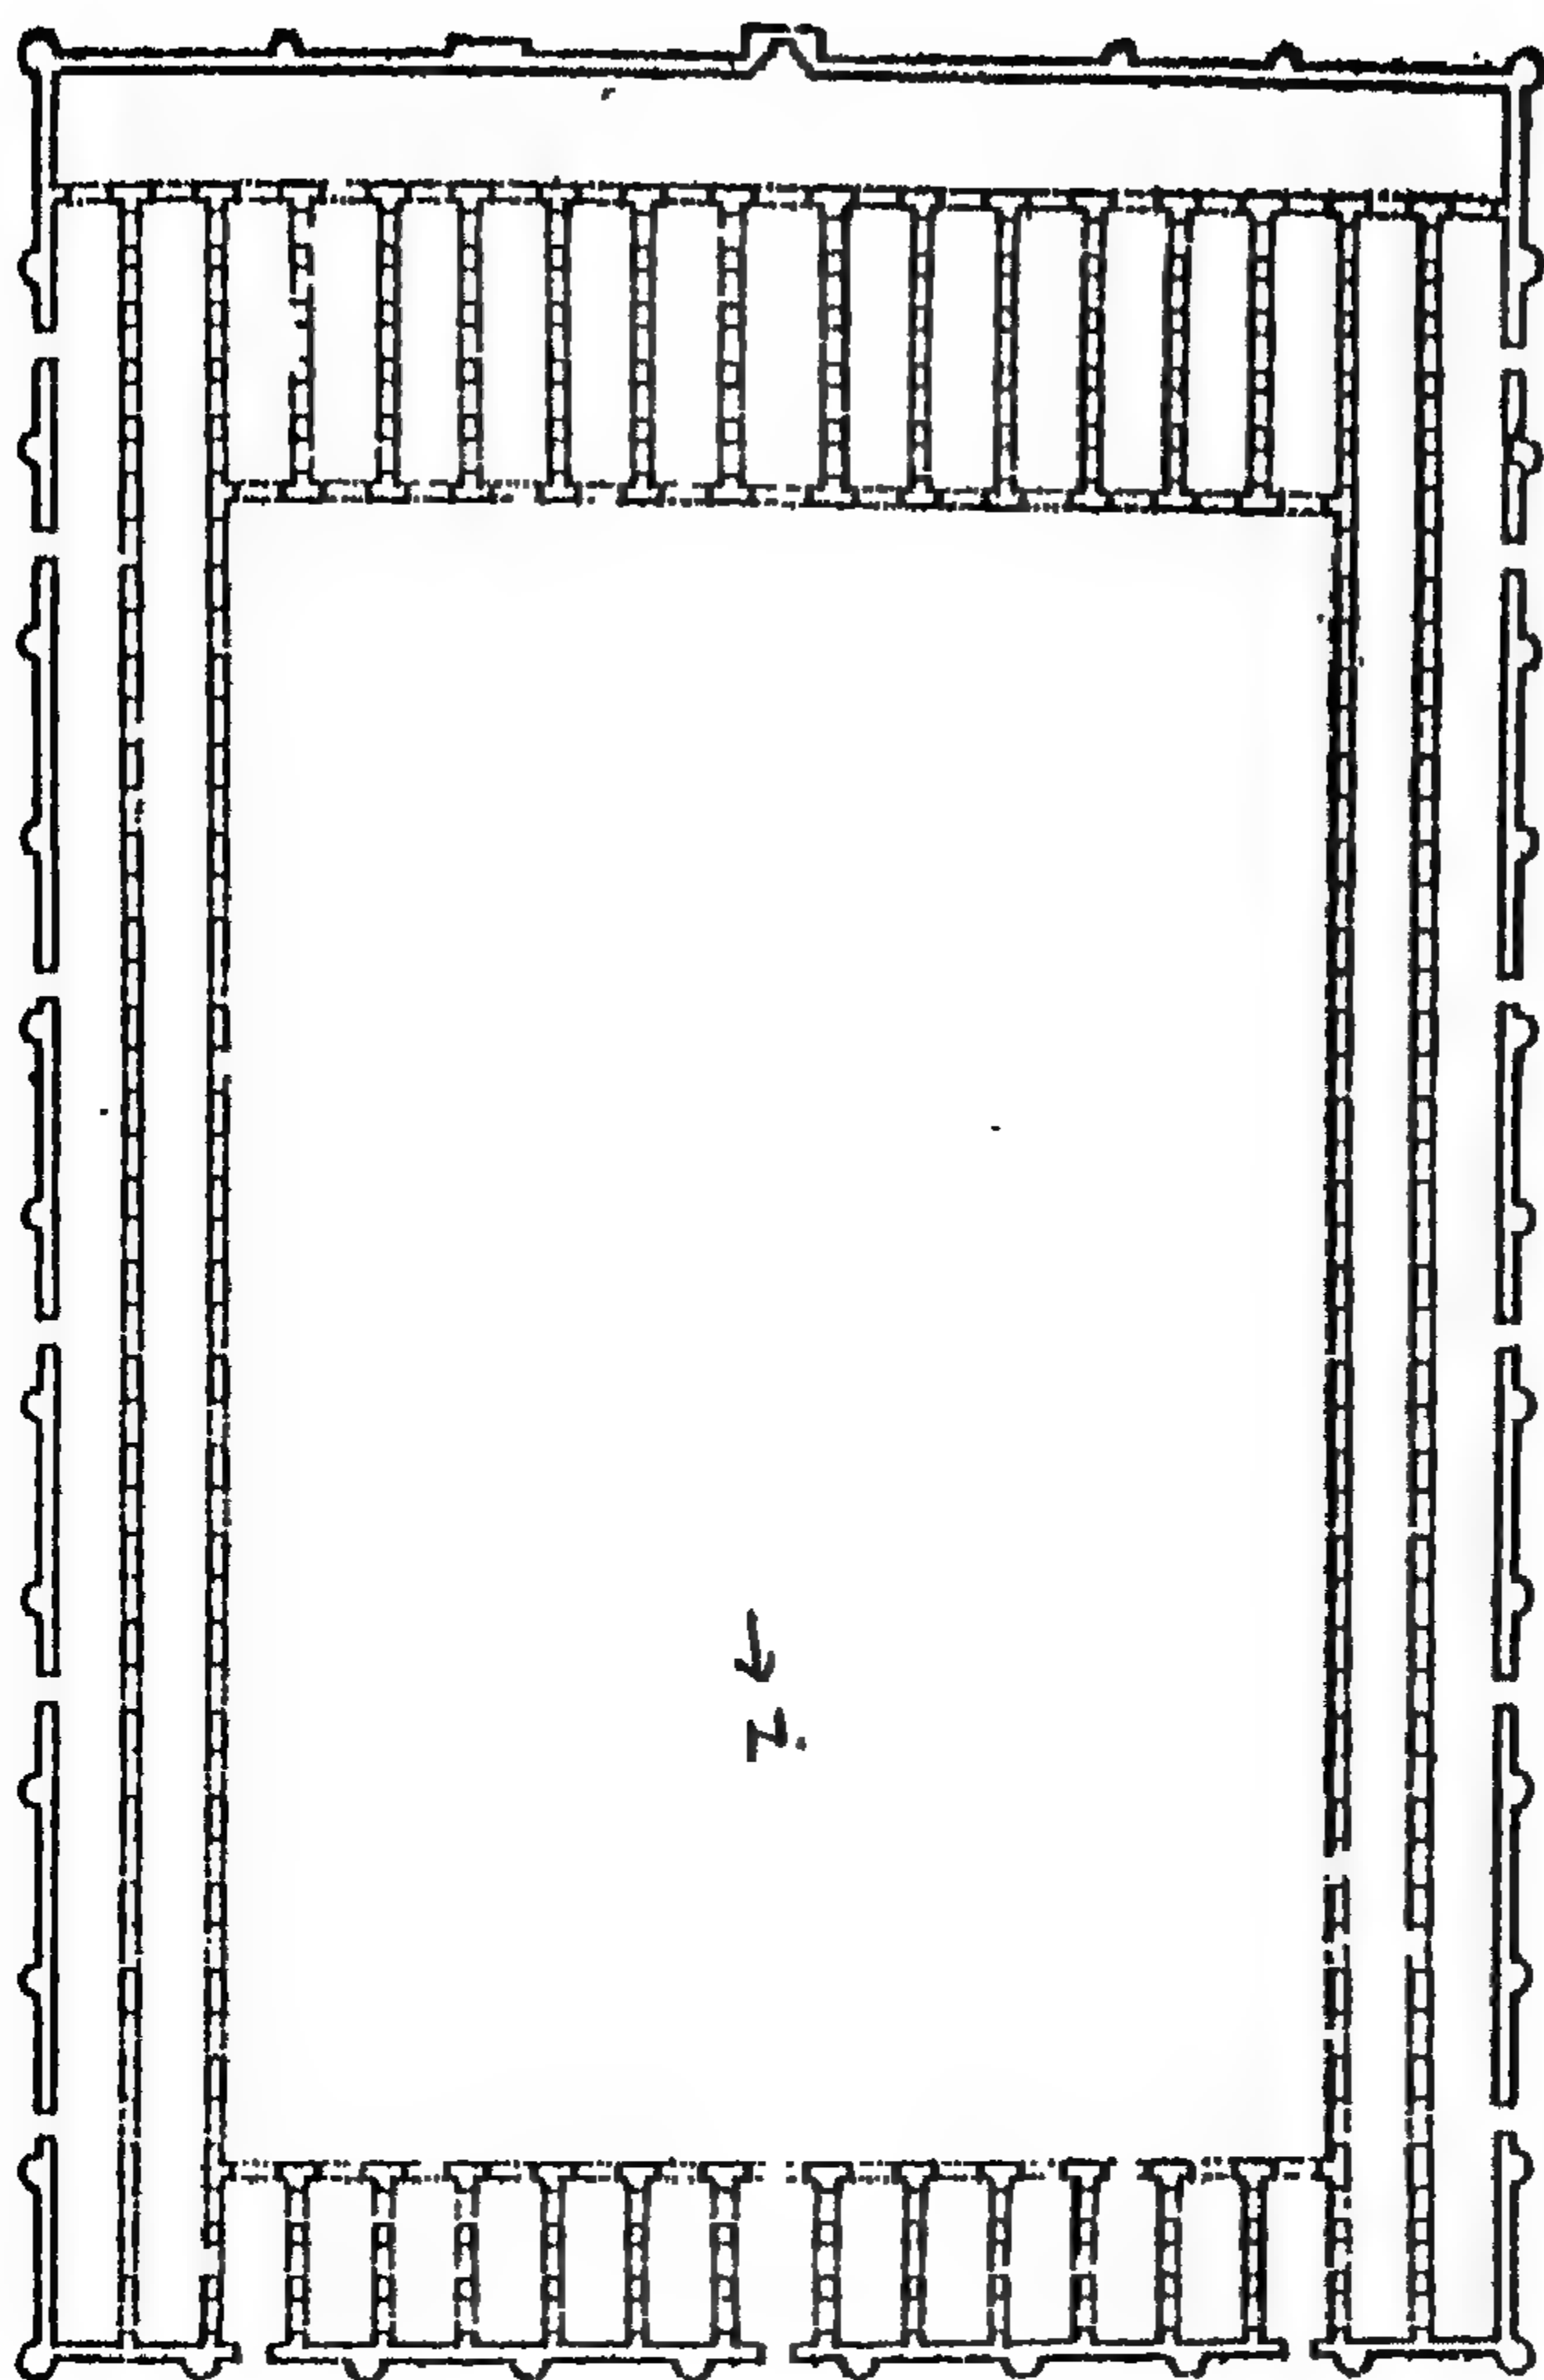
مسقط أفقي للمسجد الجامع
